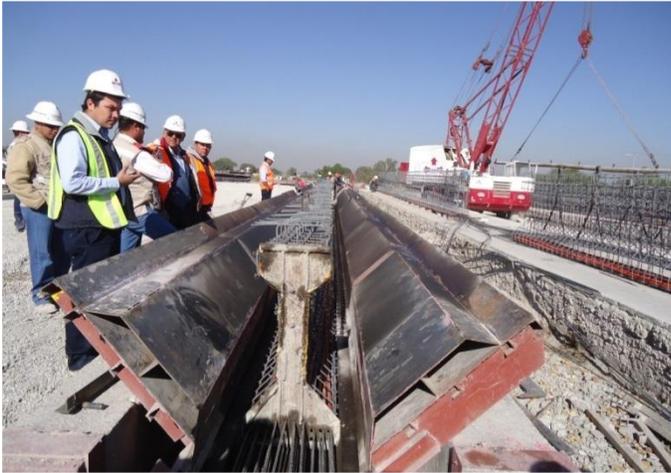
Planta de elementos prefabricados. Preteconcreto. Teoloyucan Estado de Mexico
